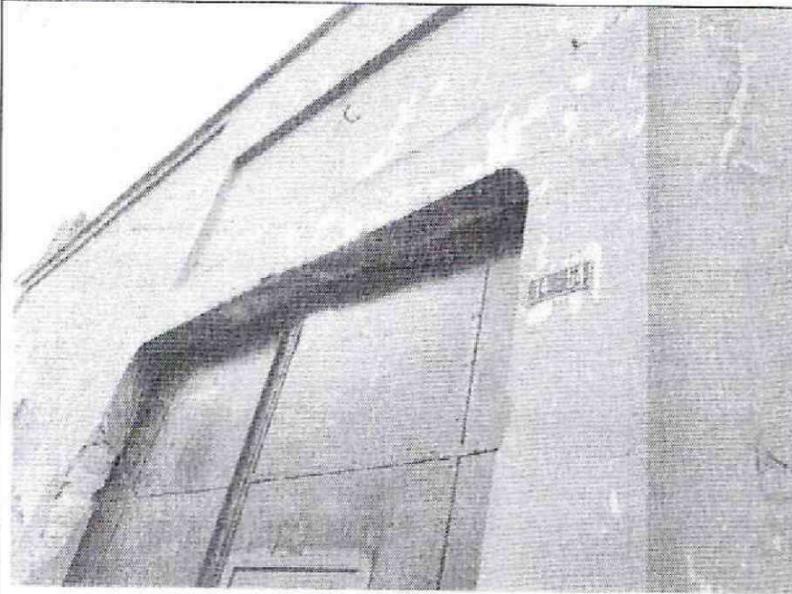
Dintel del portón, fisuras y deterioro de acabados.
